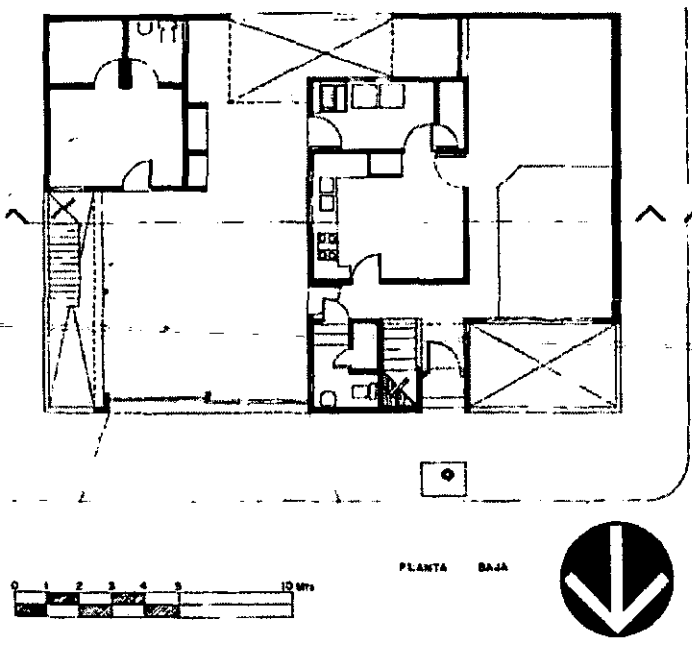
Casa Pico, plantas arquitectónicas (CRA).
